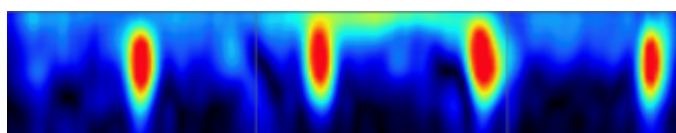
Dispunerea etrierilor în cadrul centurii de beton armat din peretele din axul A
